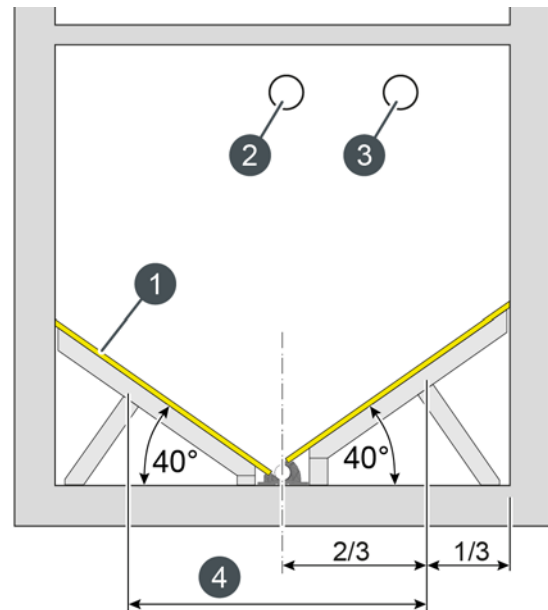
Construction du plancher incliné pour la vis d'extraction
